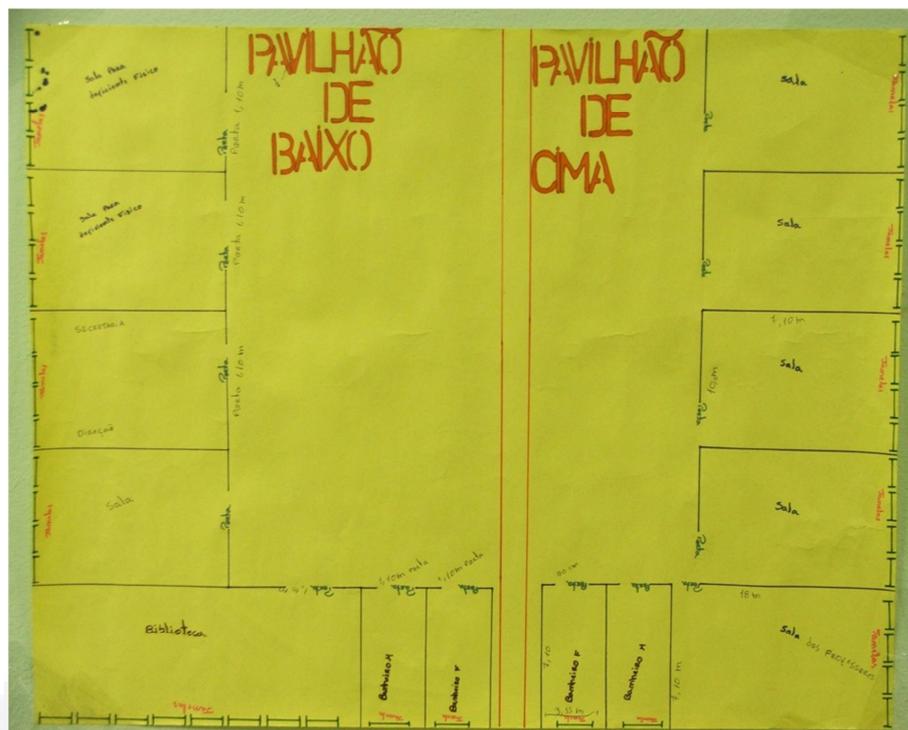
Foto da planta baixa desenvolvida pelo grupo G2.
